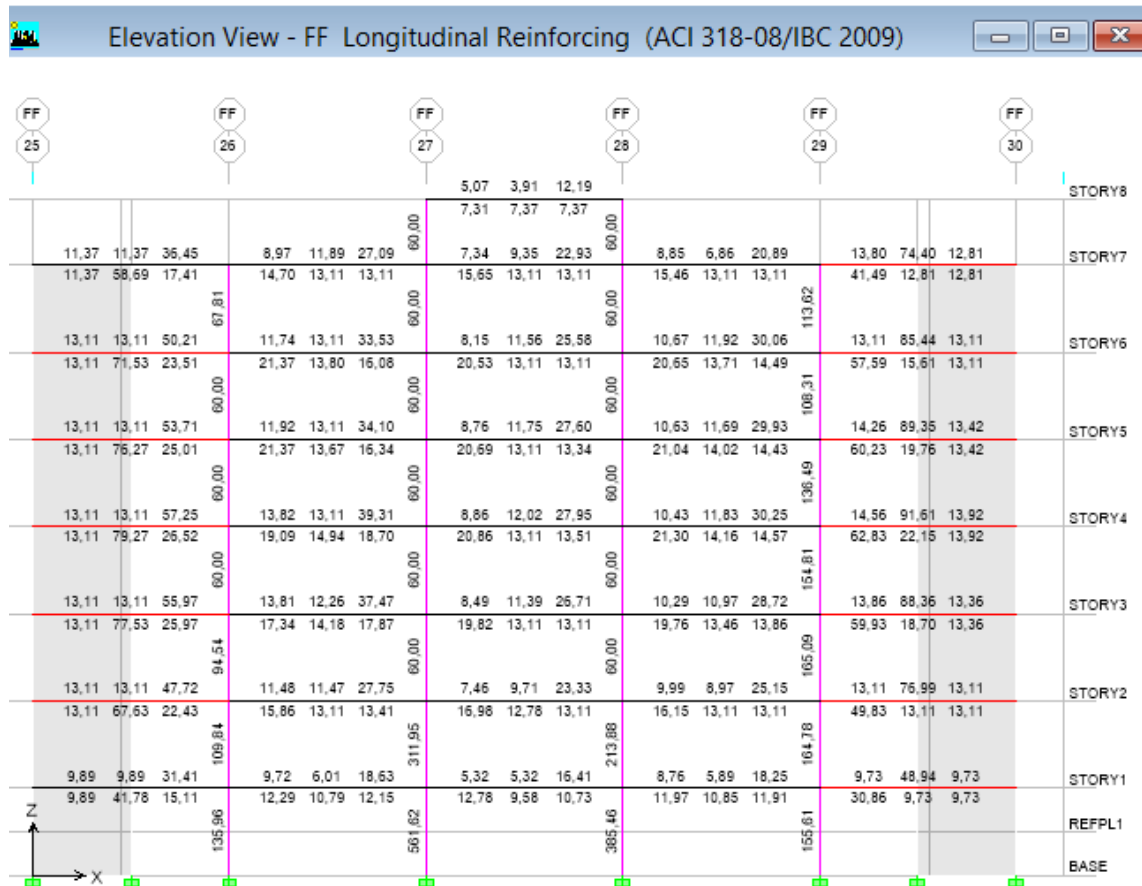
Acero en Vigas y Columnas en el Pórtico FF – Hospitalización 2- (NEC-11)
